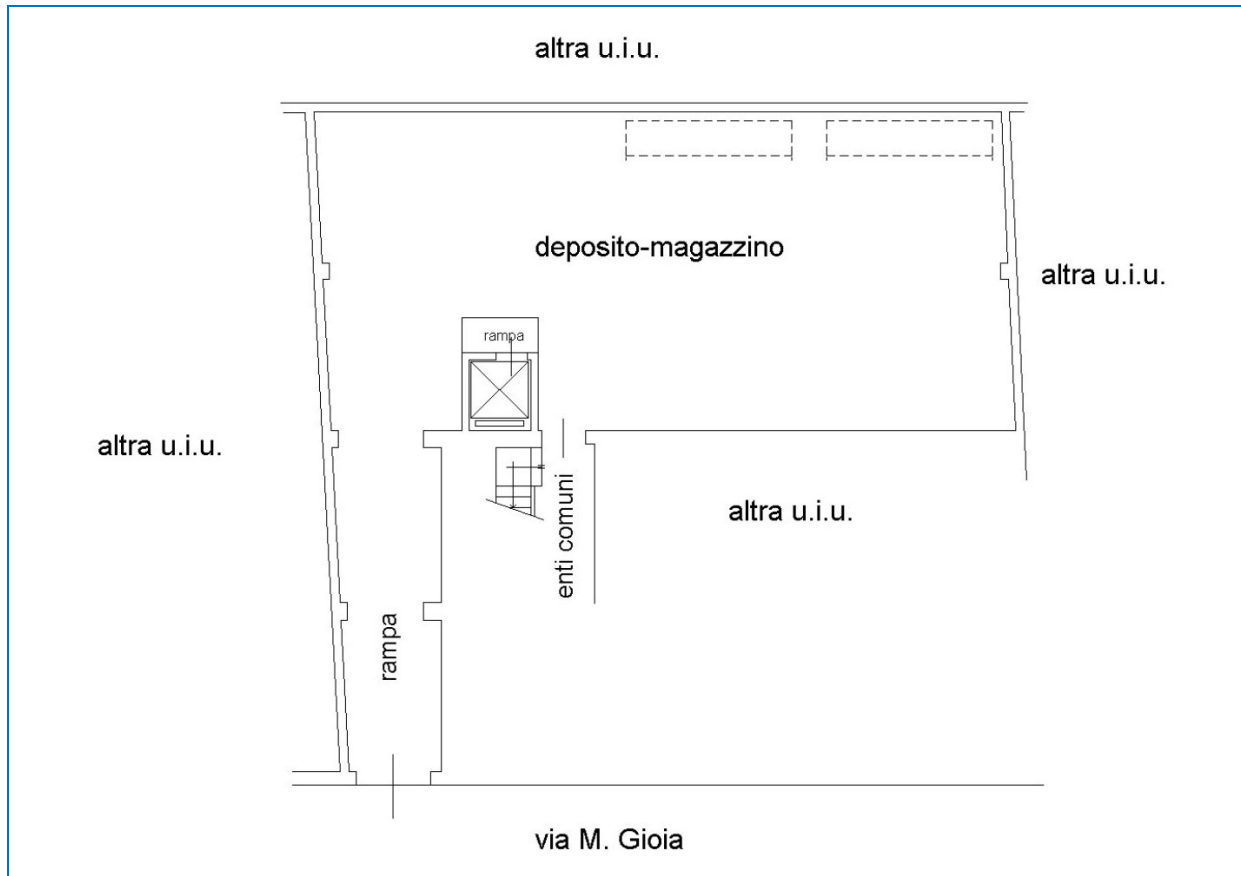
estratto planimetria catastale del deposito sub. 17 - piano S1
